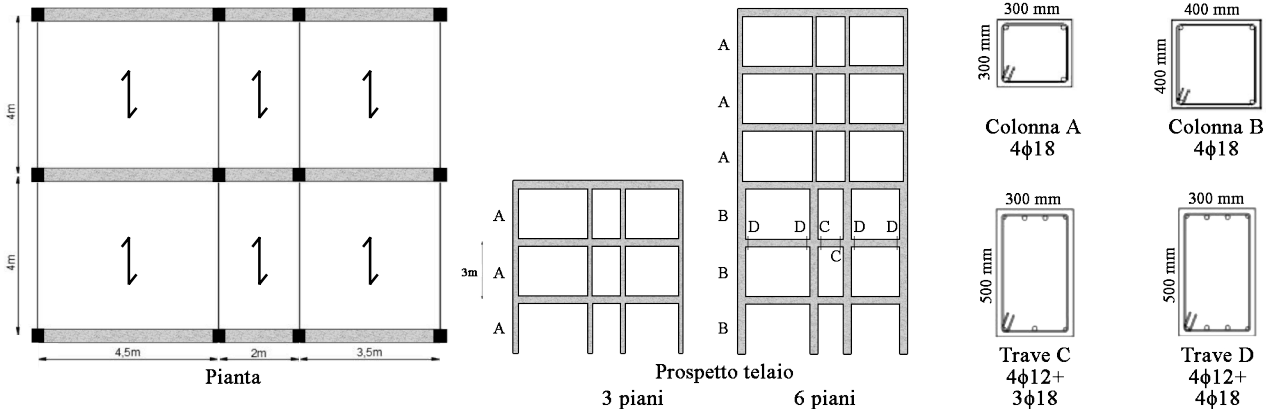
Edifici tipo: (a) pianta, (b) elevazione di un telaio longitudinale, (c) sezioni tipo degli elementi strutturali.
